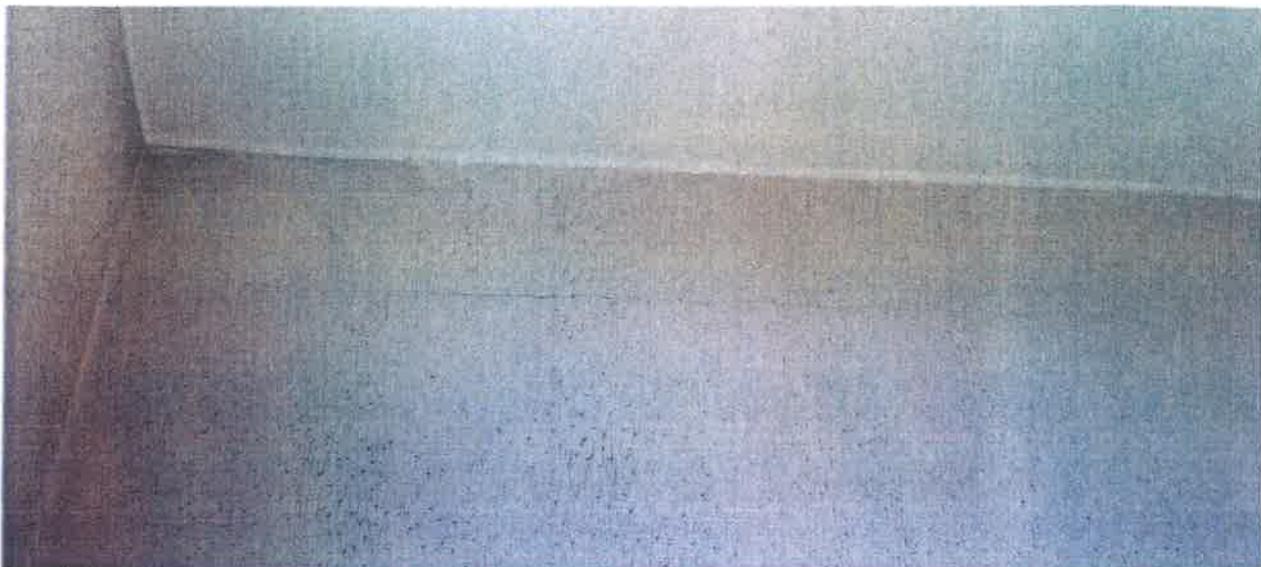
Caixa de escadas/zona acesso à cobertura – fissuras nas paredes
